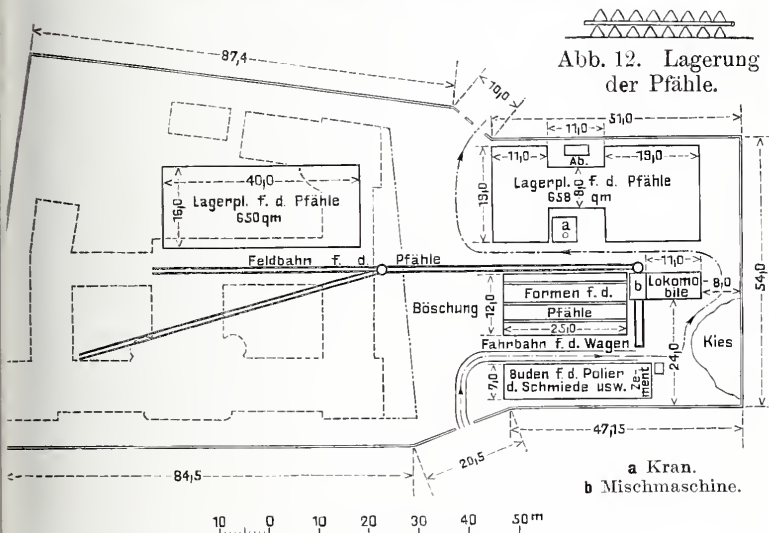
Lageplan der Baustelle und des Arbeitsplatzes.
